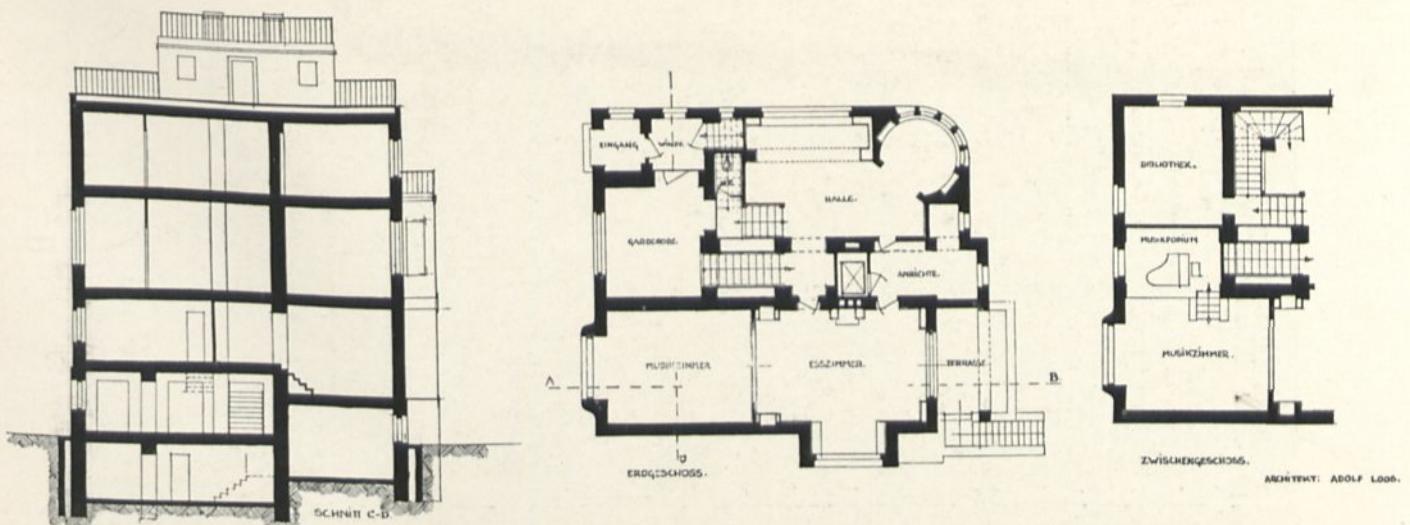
/91. Haus Strasser, Wien. Umbau. Halle
